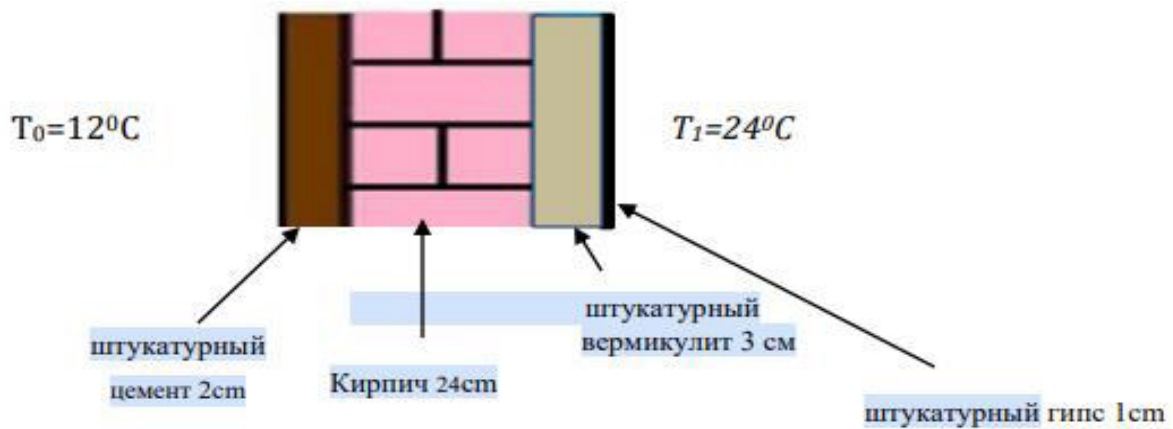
Схема кирпичной стены с теплоизоляционными слоями в зимний период
